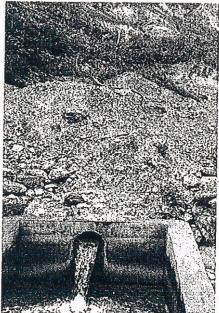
Tuberías y punto de vertimiento sobre la quebrada La Baja
